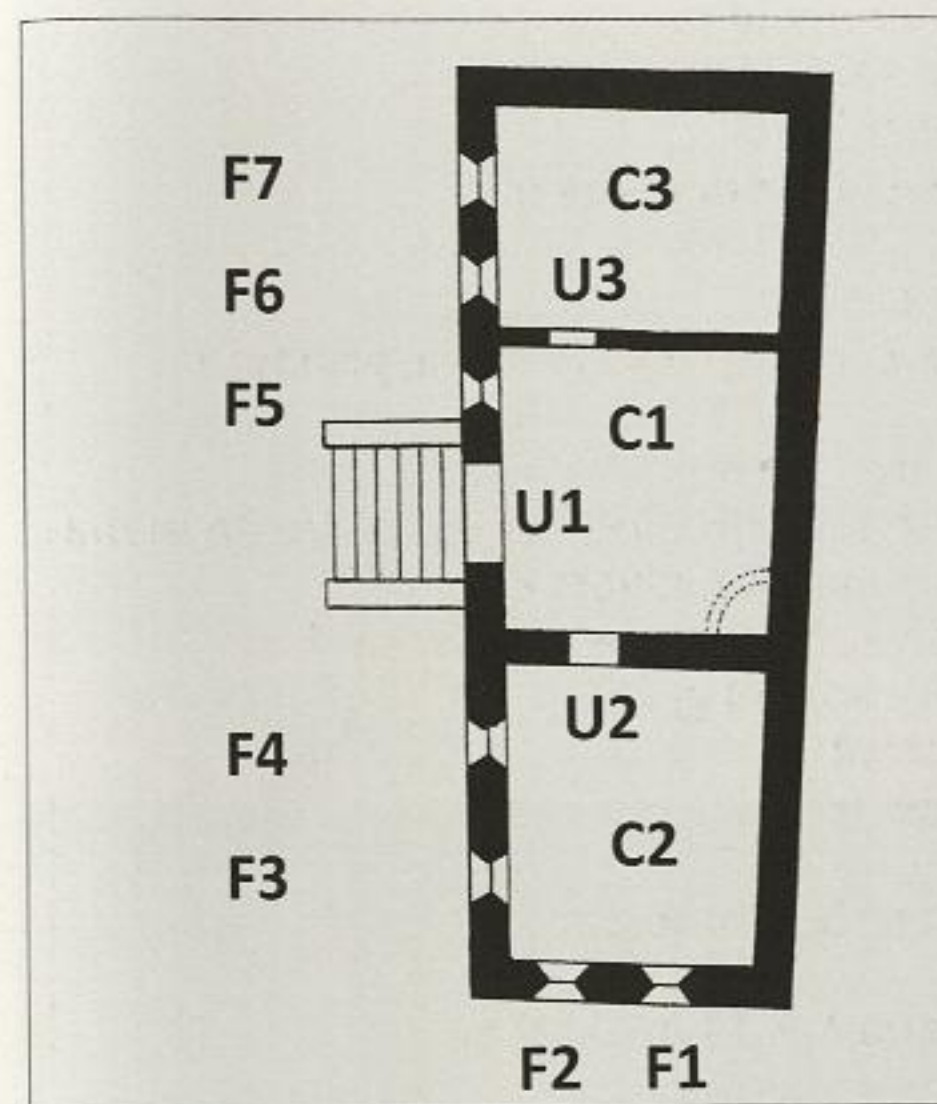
Orientierungsplan mit Eintragung der Räume, Fenster und Türen
